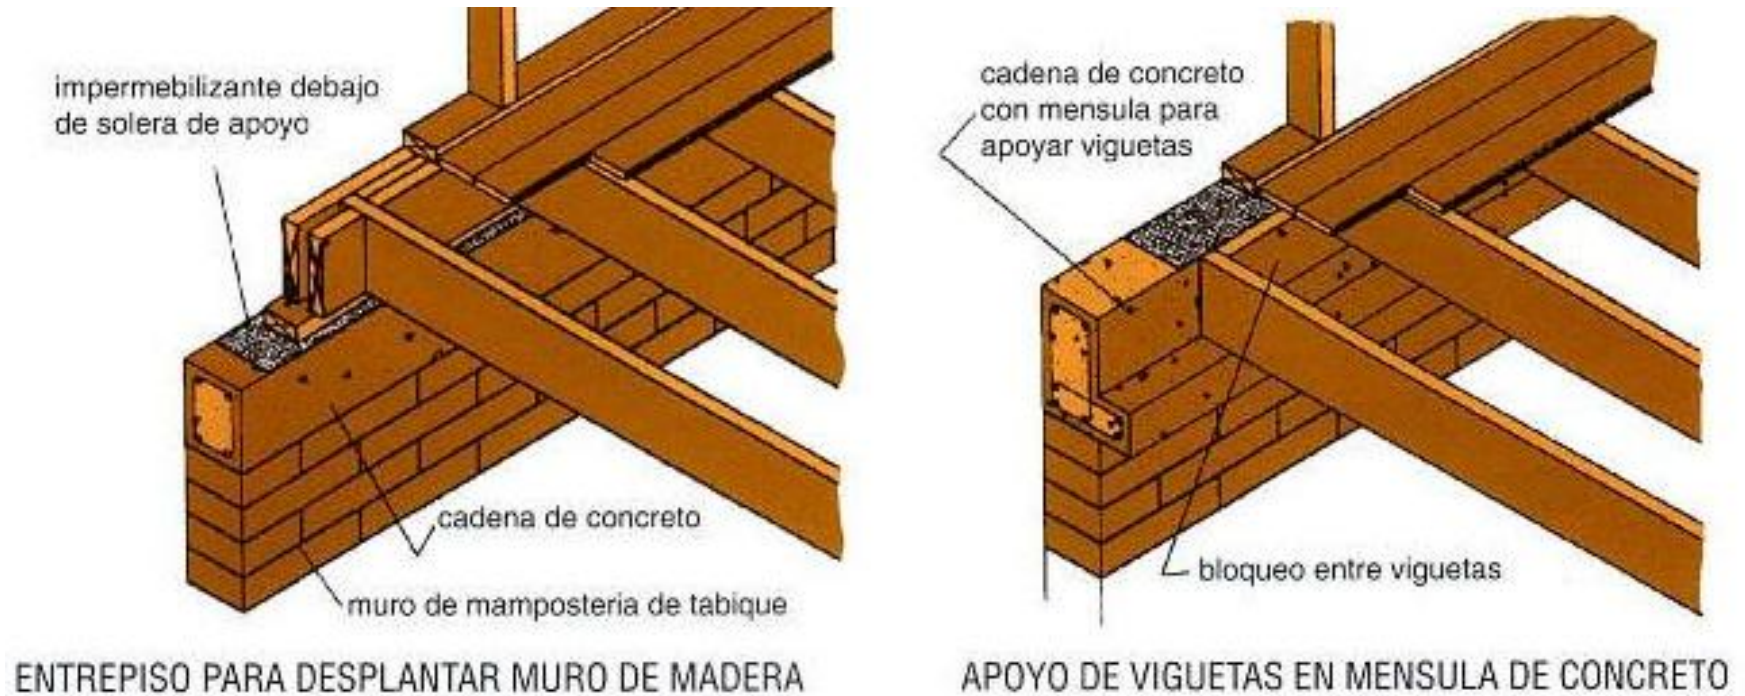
Apoyo de Viguetas sobre Muros de Mampostería.
